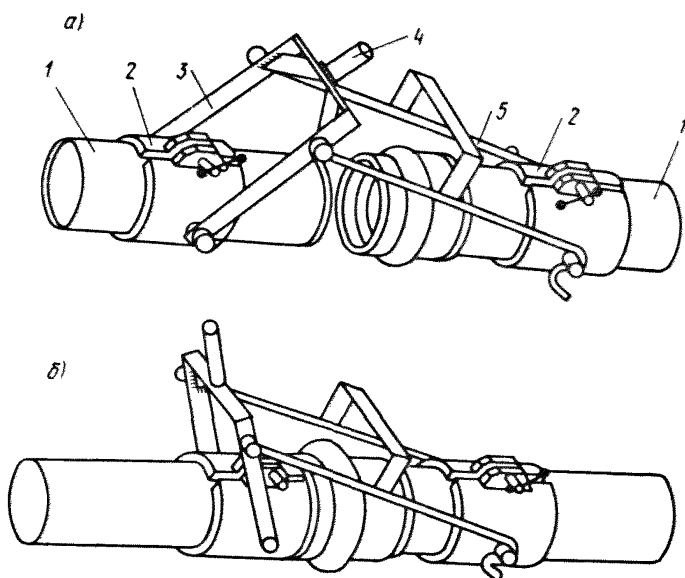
Рычажное натяжное приспособление для соединения раструбных труб
